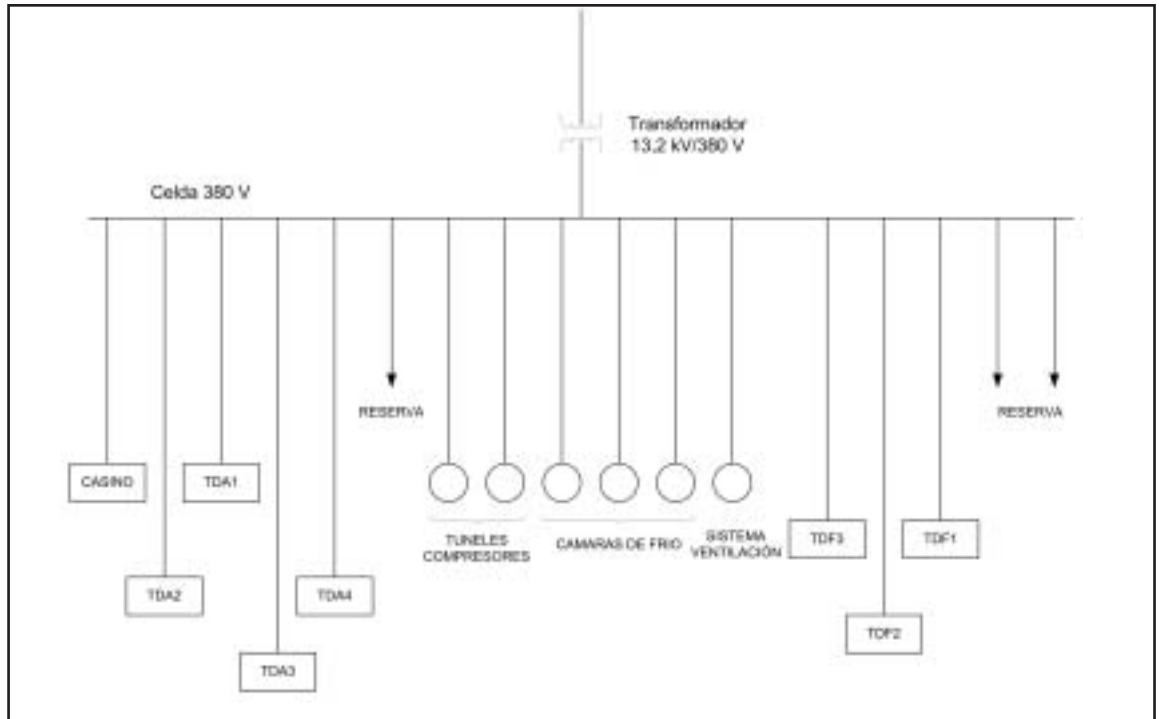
Esquema de planta faneadora y procesadora de alimentos.
